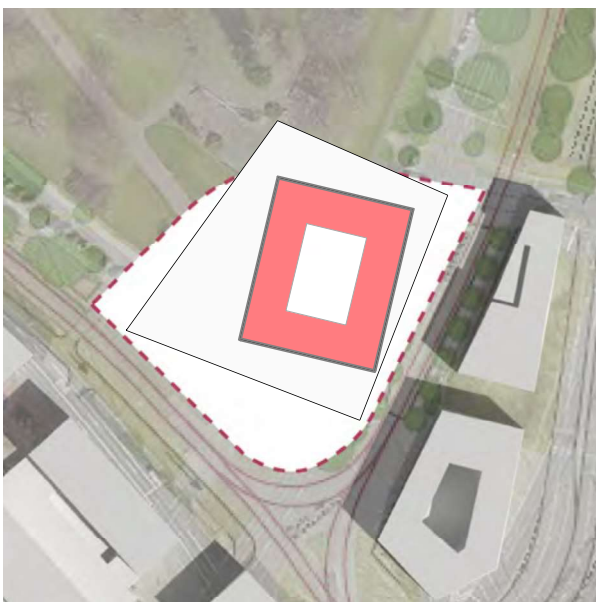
Grundriss OG4 Bahnhofsquartier V1
